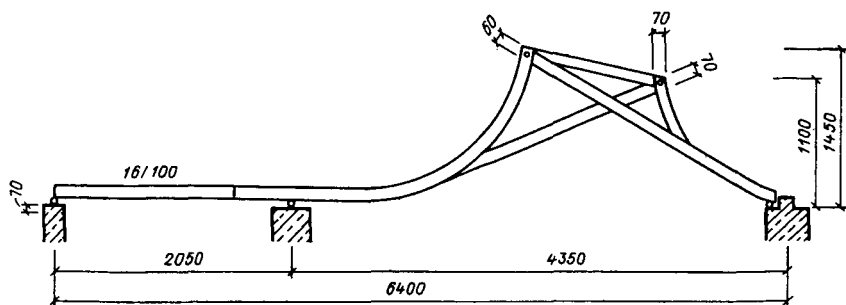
Поперечный разрез конструкций плавательного бассейна в Берке, Франция
